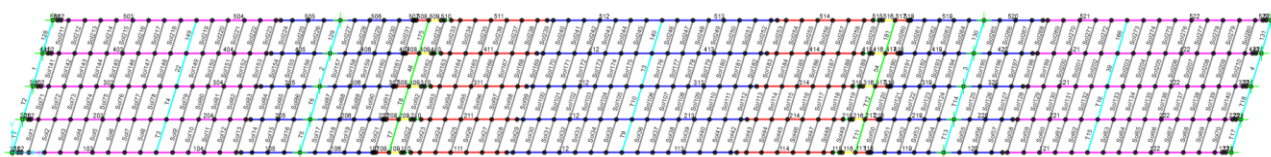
Modellazione campata con numerazione frame (vista in pianta)
